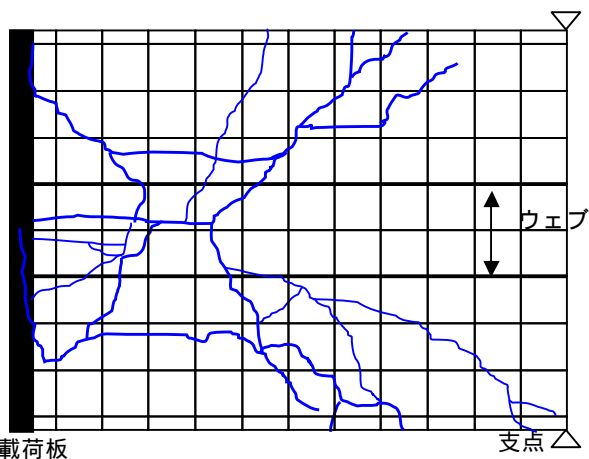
No.4 フランジ上面ひび割れ図 (実験終了時)
